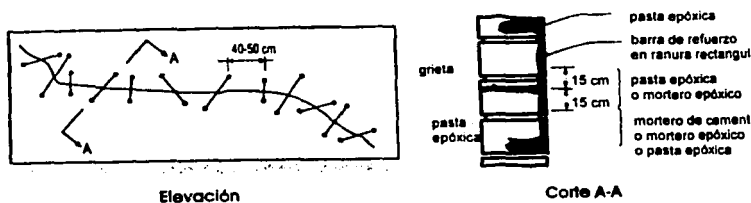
Colocación de grapas sobre grietas en muros de mampostería.
